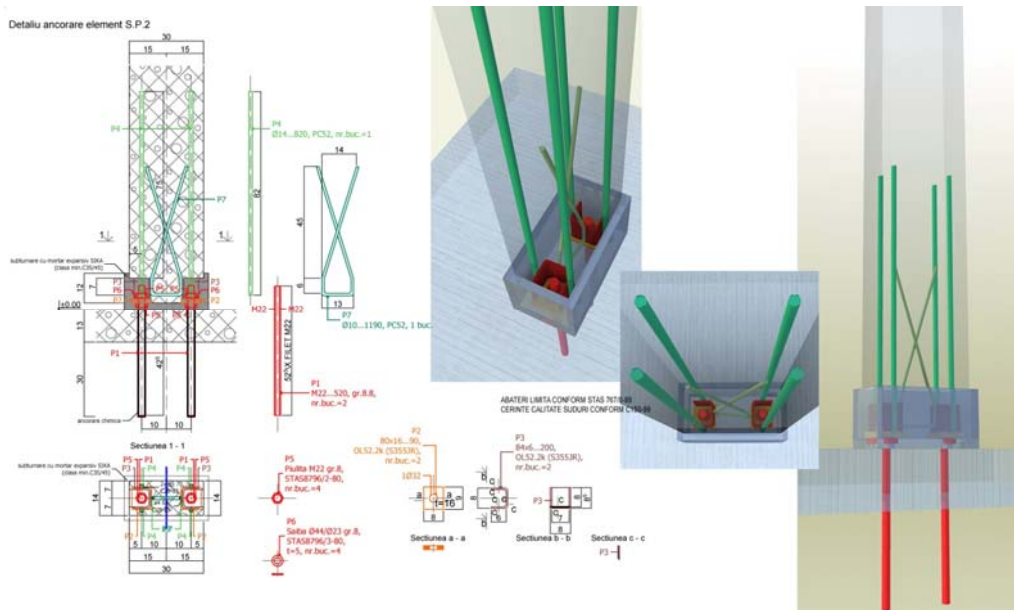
Element prindere stâlp marginal SP2 pe structura existentă
